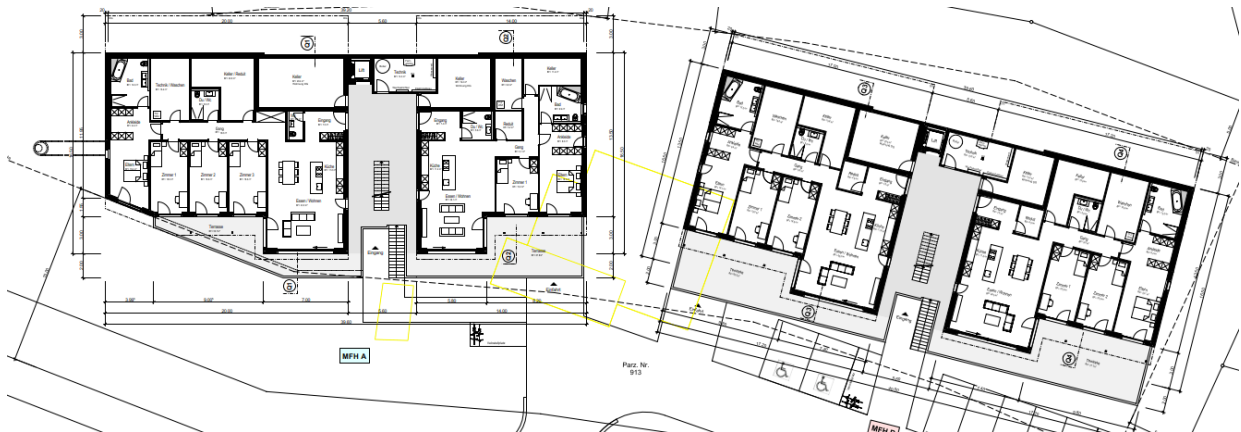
Richtprojekt: Grundriss Erdgeschoss
